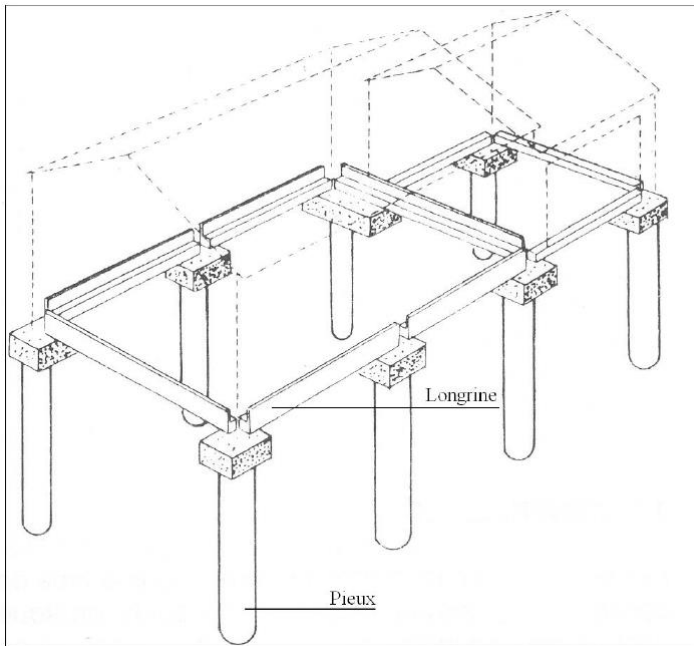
Fondations sur pieux (d'après Ersnt Reuter)
